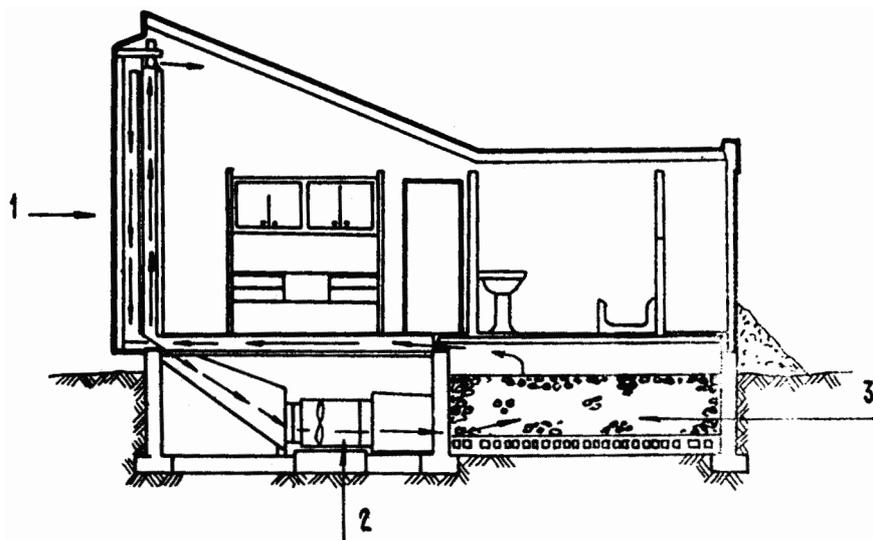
Поперечный разрез дома с солнечным воздушным отоплением (Канада):
